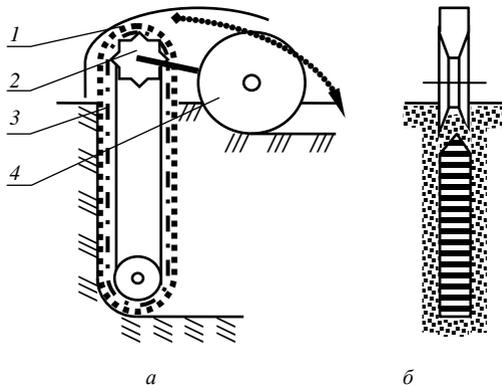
Схема цепного скребкового рабочего органа для щелевого дренажа: а — вид сбоку; б — вид сзади; 1 — кожух; 2 — ведущая звездочка; 3 — рабочая цепь; 4 — закрывающий аппарат
